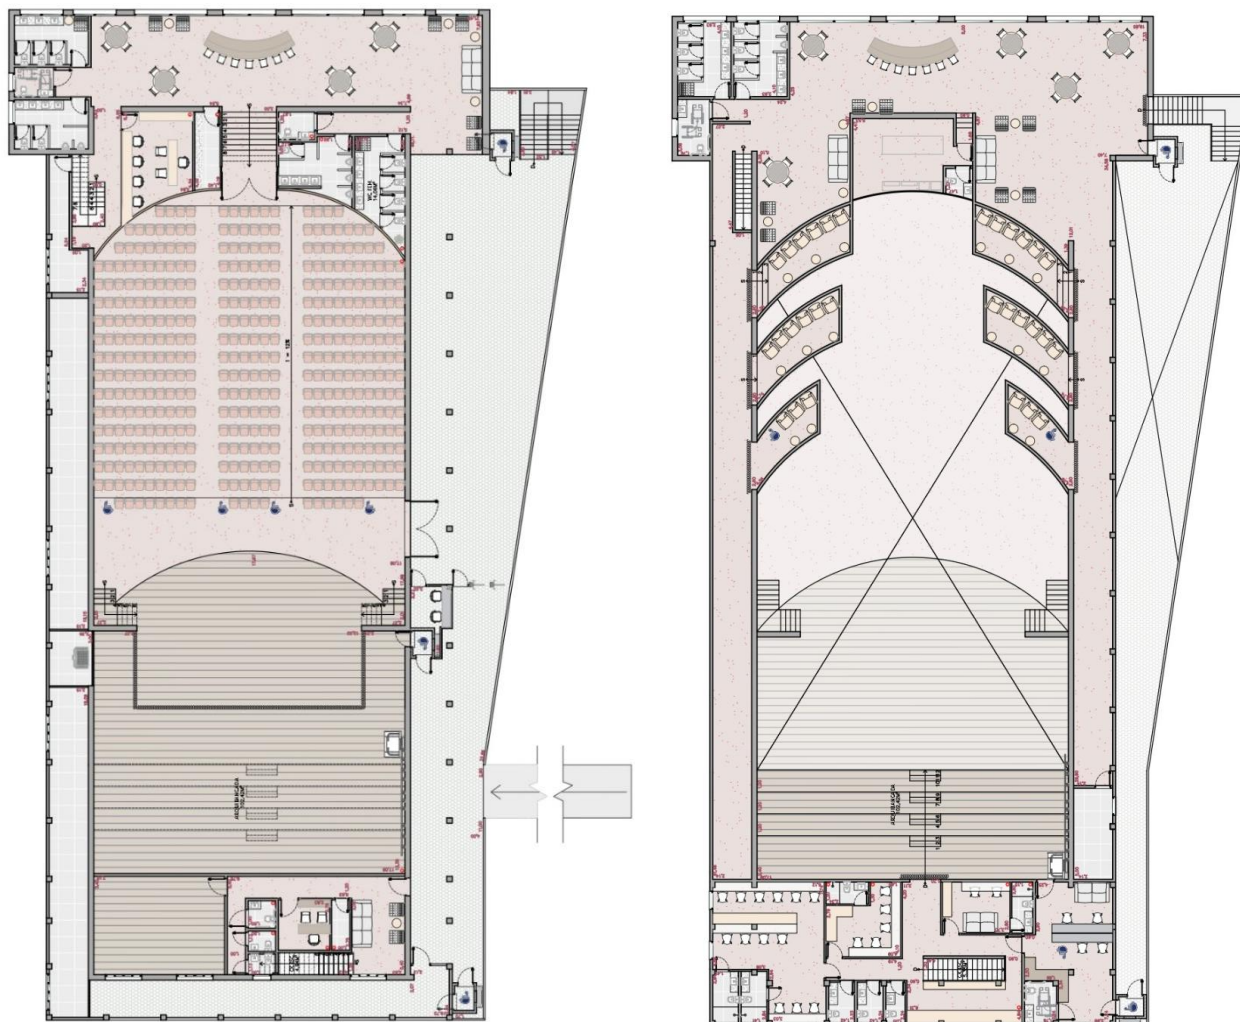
Plantas baixa de primeiro e segundo pavimento. S/E.
